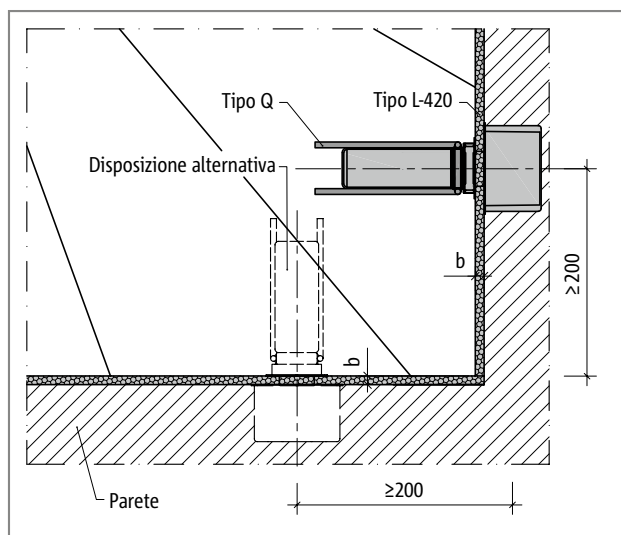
Schöck Tronsole® tipo Q, disposizione dell'elemento, dettaglio A, larghezza giunto $b = 15 \text{ mm}$ per costruzioni in opera; per rampe delle scale prefabbricate è necessario che il progettista verifichi un'ulteriore tolleranza di montaggio.
